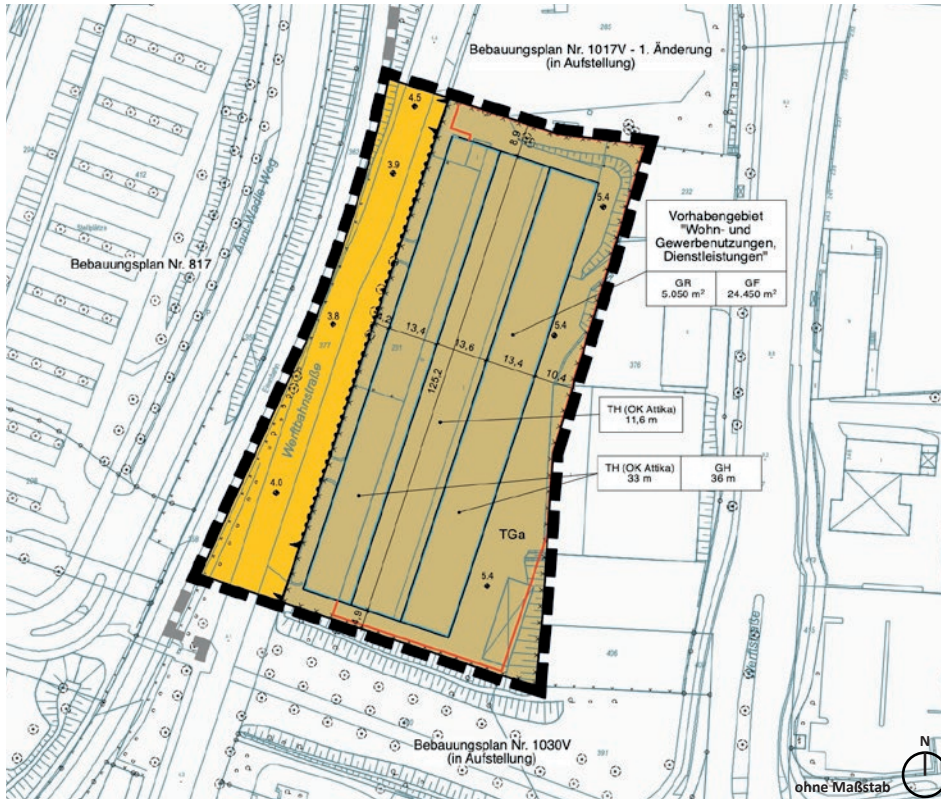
Auszug Planzeichnung Bebauungsplan-Entwurf Nr. 1031V (Landeshauptstadt Kiel, Stadtplanungsamt, Stand: 12.08.2022)
